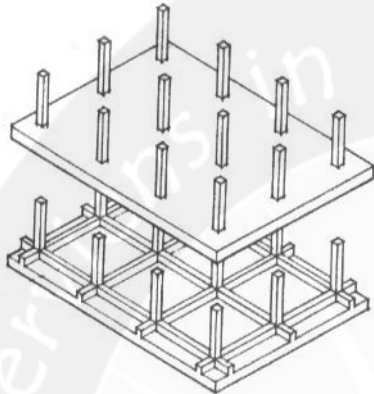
Sistem struktur kolom – balok – slab beton bertulang
